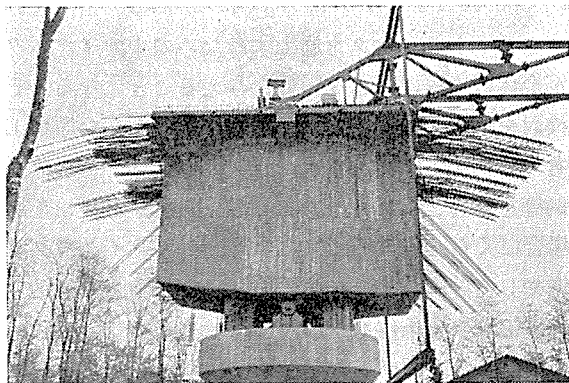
柱頭部コンクリートブロックおよびワーゲン組立
